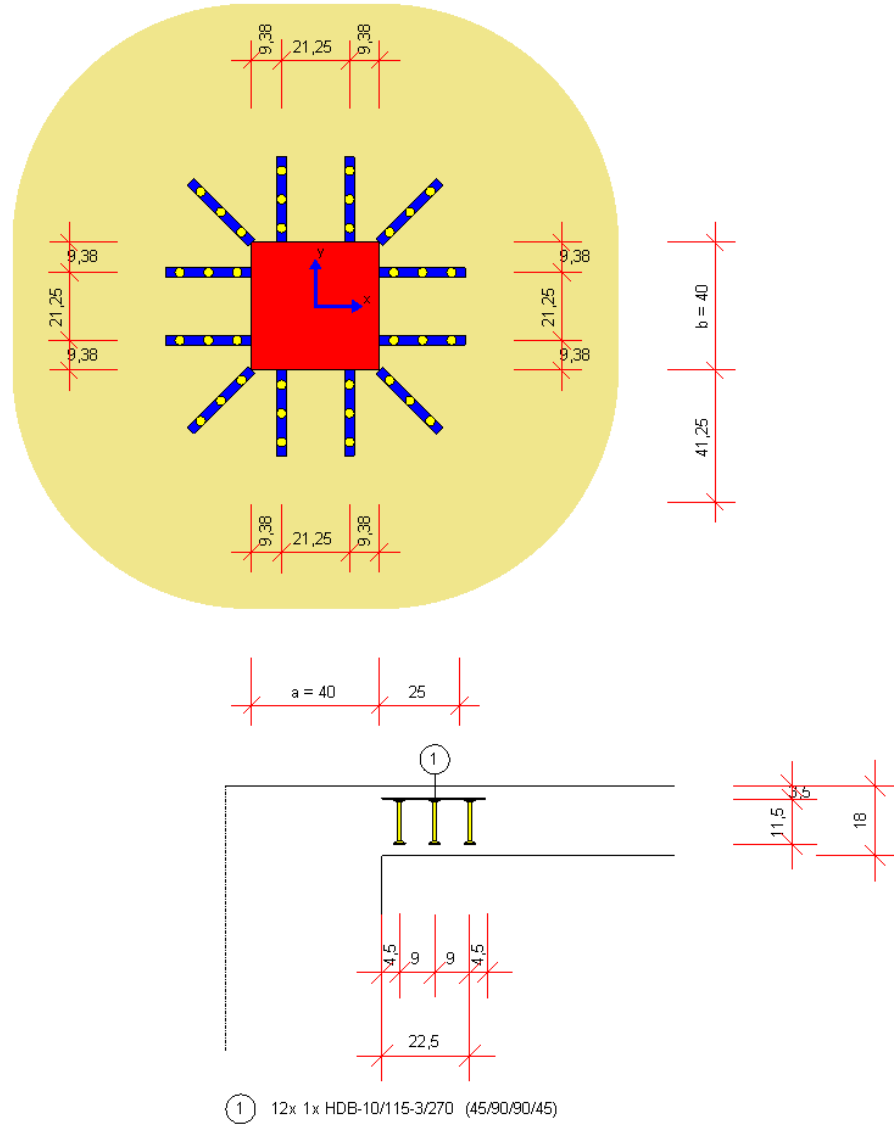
HDB-Ergebnisse in 2D (Grundriss und Schnitt)
